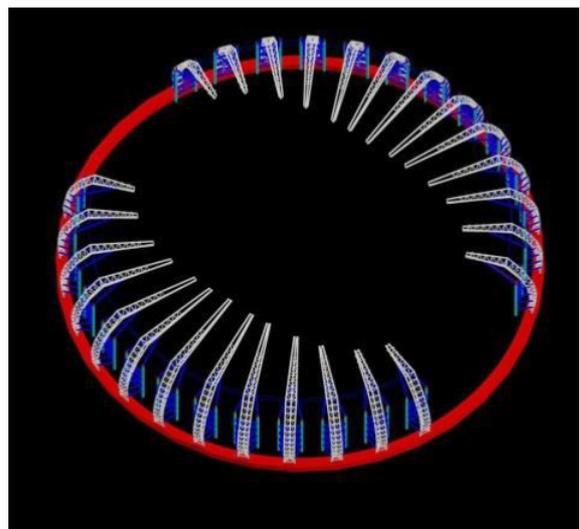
Photo qui montre des poteaux curvilignes en cours de construction
